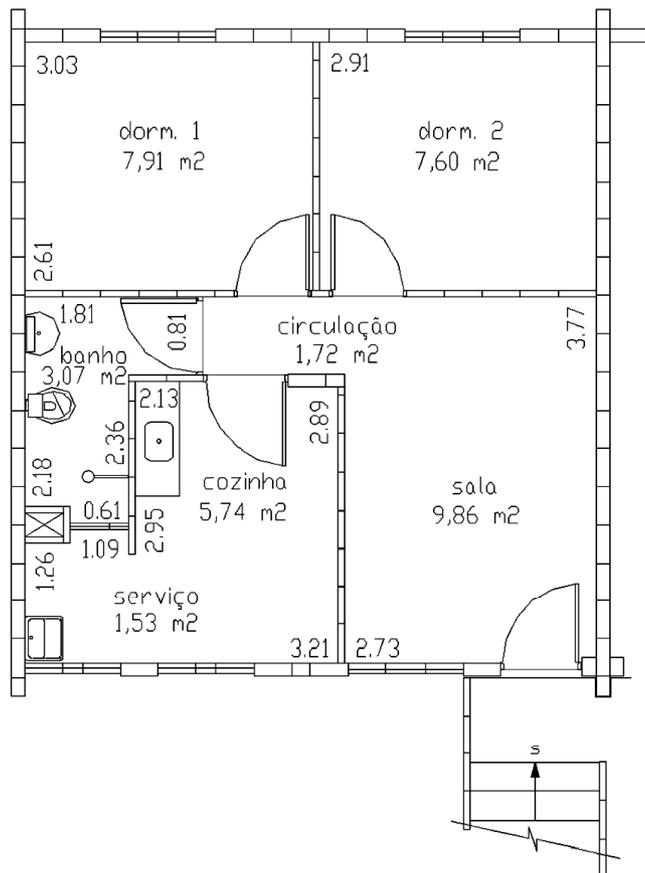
Planta 5, apartamento padrão VG.22: A – Projeto original com algumas alterações efetuadas pelos moradores
